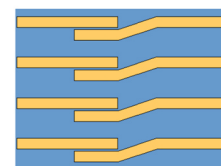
Tampilan kolom lantai 5 struktur ramp (Sumber: Tekla Structures, 2023)
